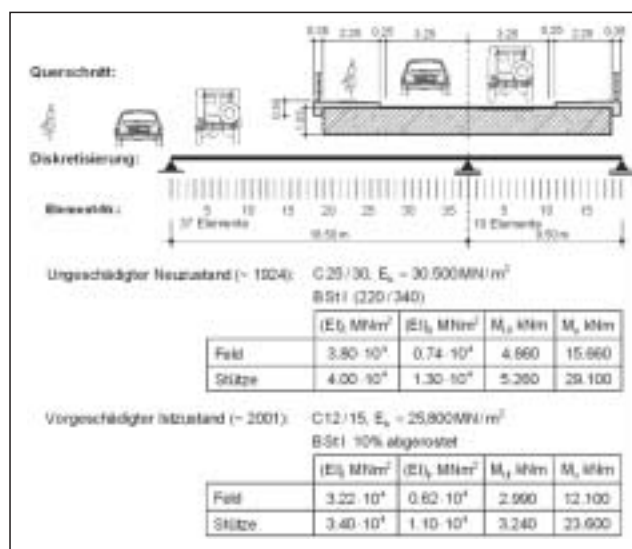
Querschnitt, Diskretisierung und Schädigungsszenarium einer Stahlbeton-Plattenbrücke
